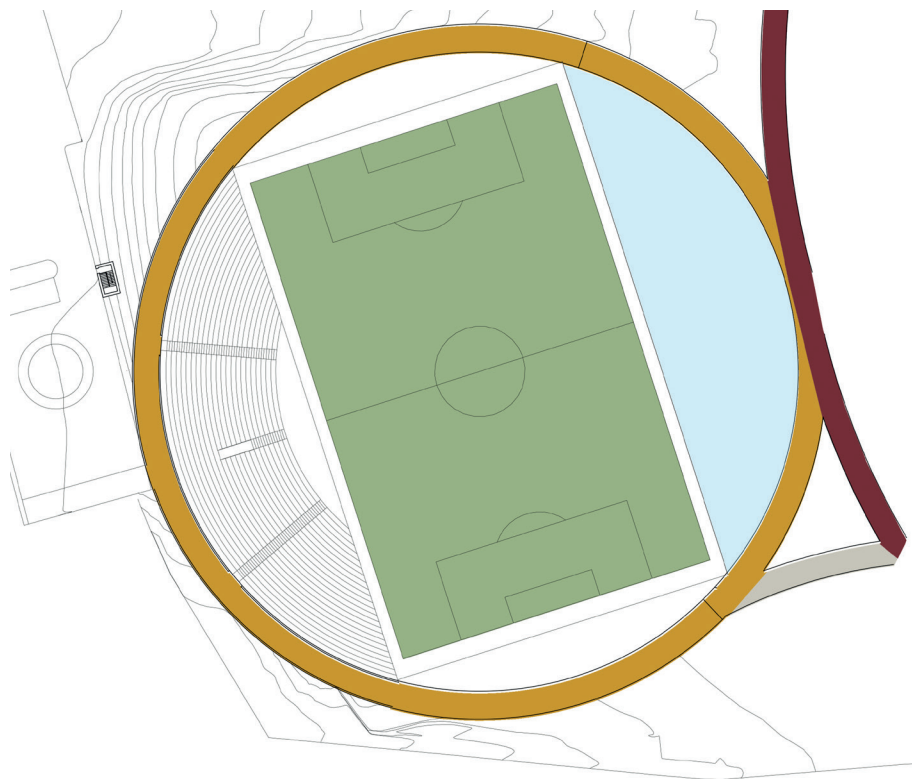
Planta do piso térreo do estádio. Realizado em CAD pela autora.
